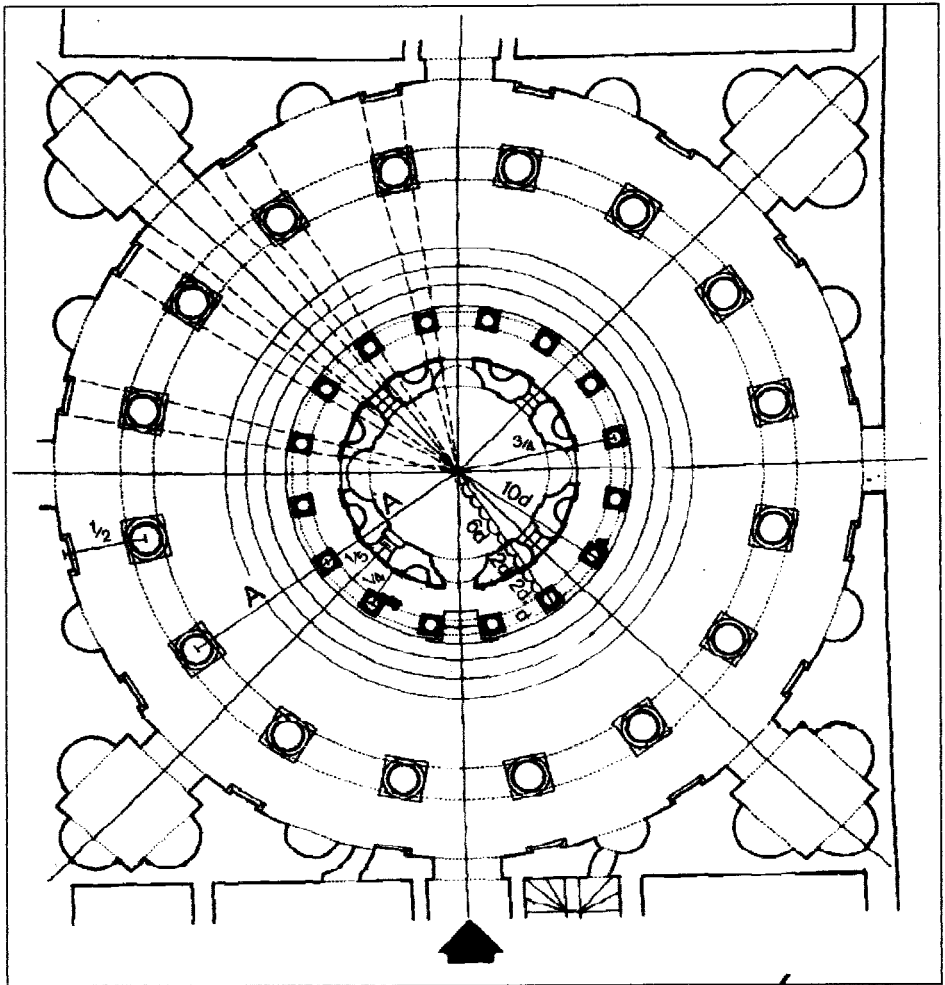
Planta hipotética del proyecto de Bramante para el *Tempietto de San Pietro in Montorio
